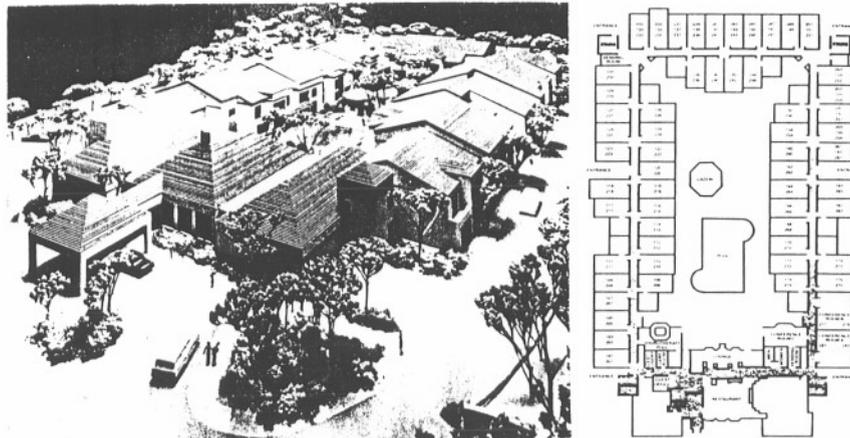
Courtyard by Marriott, Marriott Hotels, Atlanta - GA. Vista e planta baixa.
